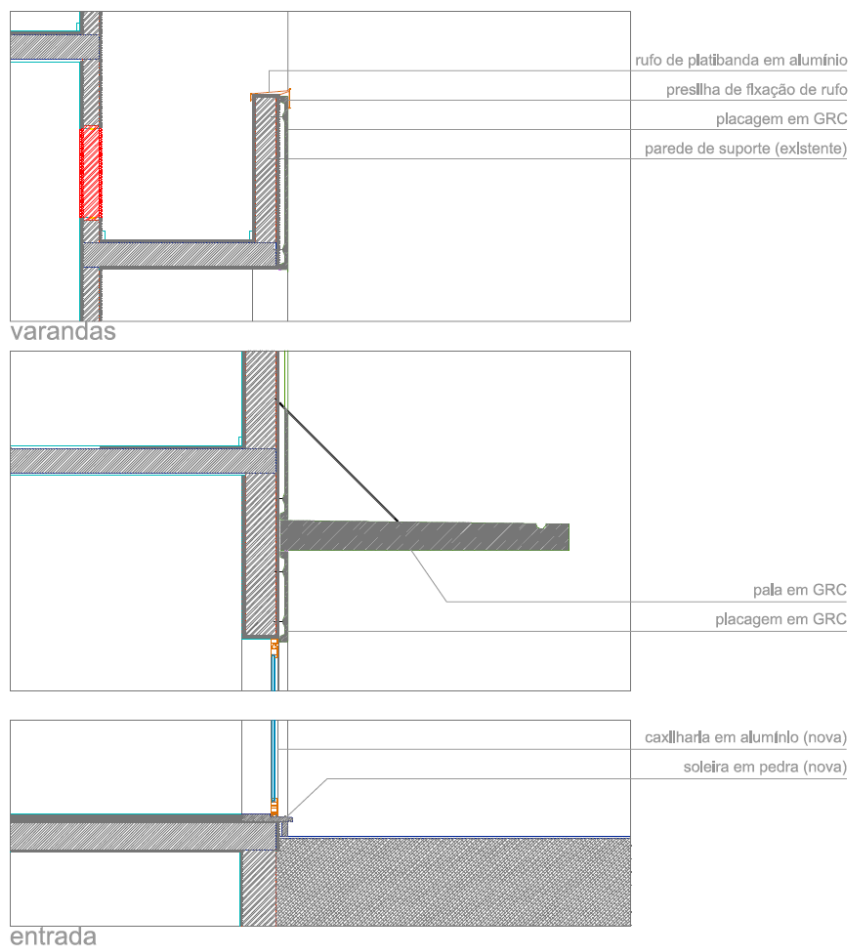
Intervenção proposta na fachada. Corte construtivo (escala 1/50).
